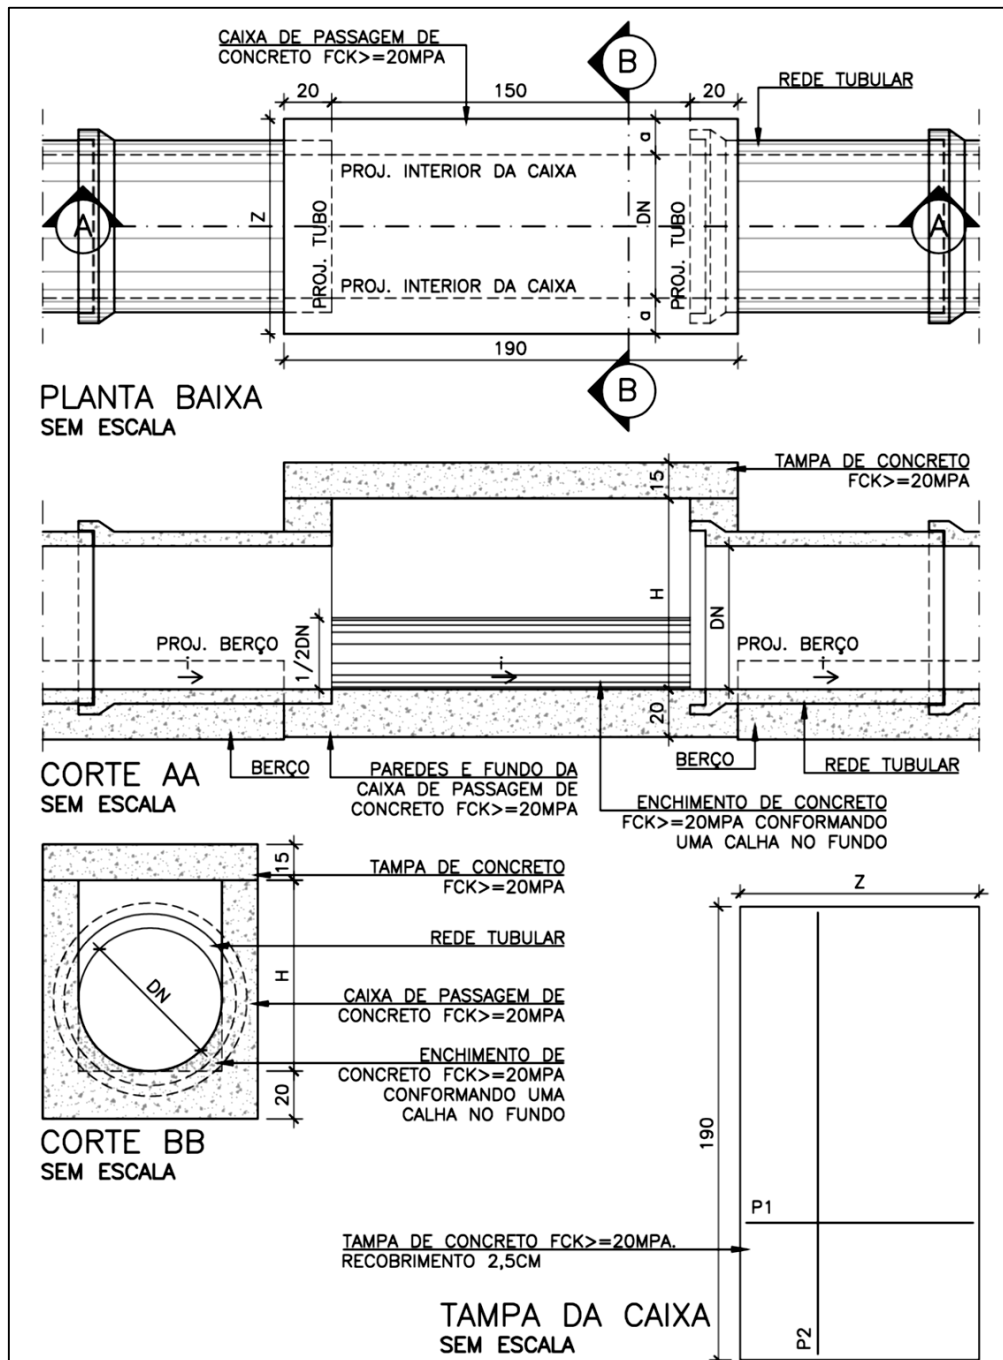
Caixas de passagem tipo A. Fonte: SUDECAP, 2019.
